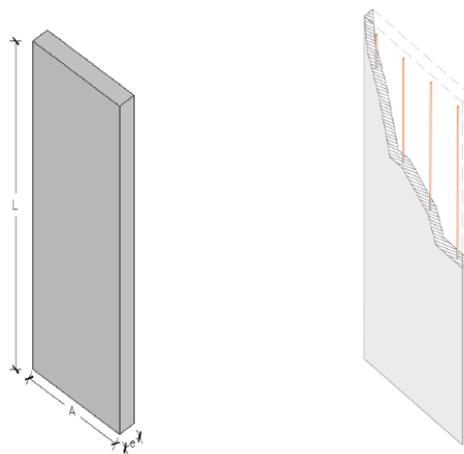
Paneles divisorios de Concreto Celular / Imagen de las fichas técnicas AICRET SMKT
